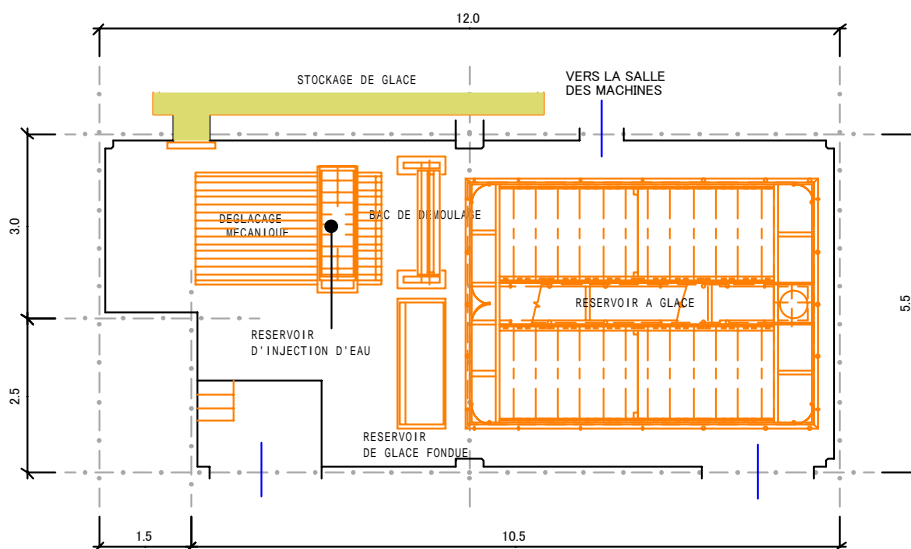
Plan planimétrique de la fabrique de glace
